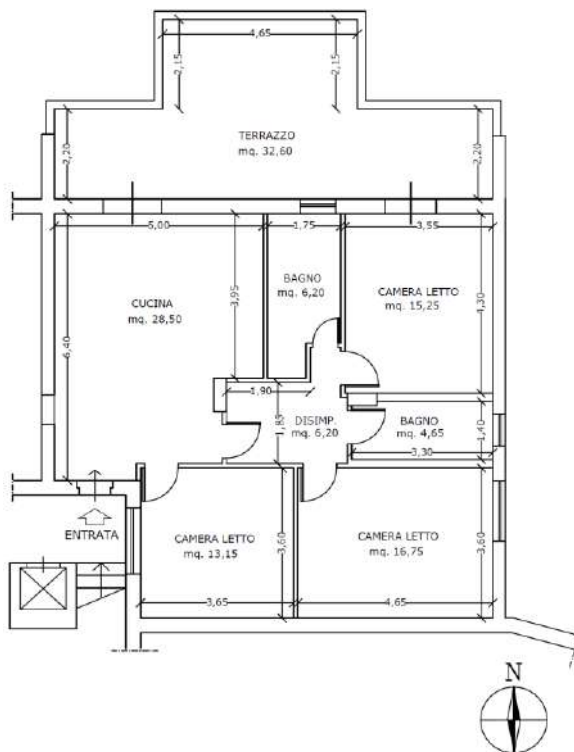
\_ Rilievo planimetrico appartamento pignorato.
